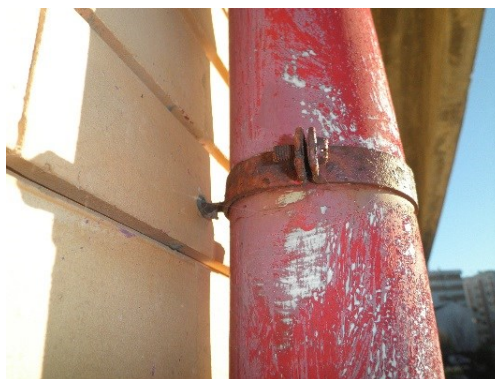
Pormenor corrosão de elementos de fixação dos tubos de queda [4].
